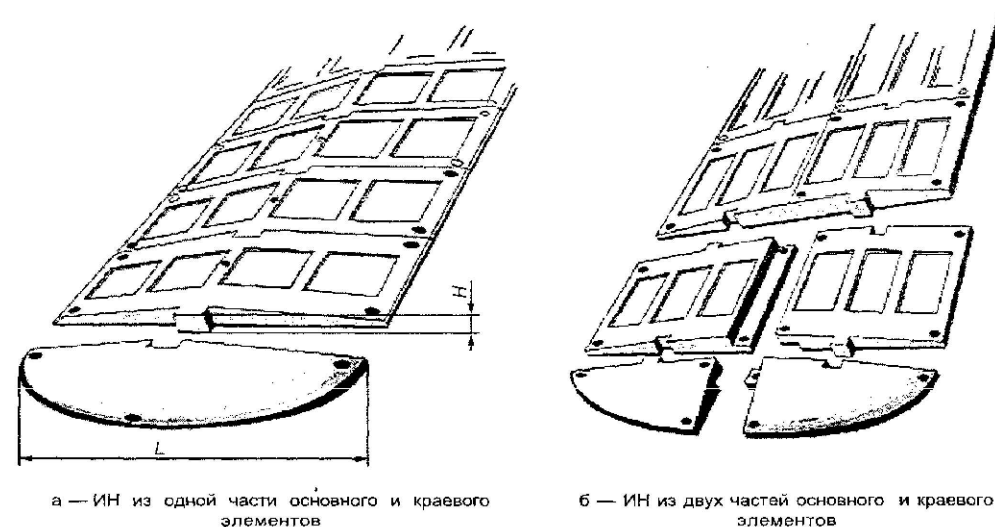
Конструкция сборно-разборной искусственной дорожной неровности
